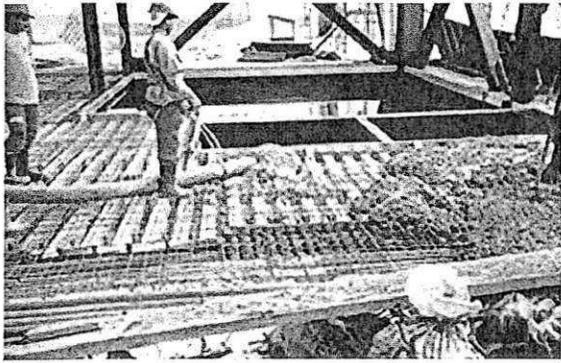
Concretagem do steel deck utilizando uma tela eletrosoldada para evitar fissuras na camada superior e como armadura negativa.
